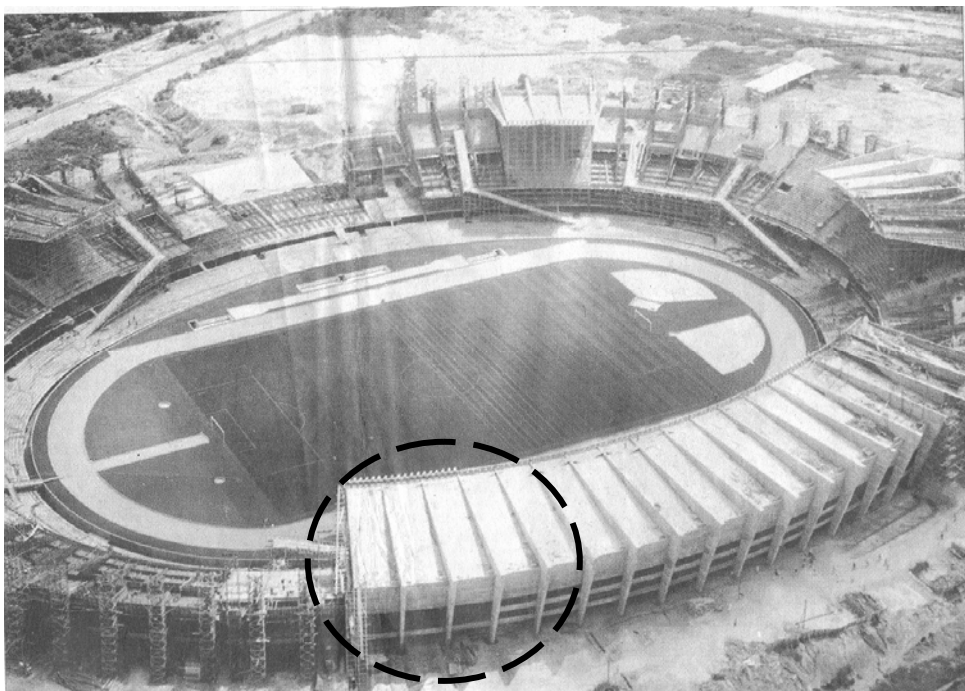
Foto tirada durante a construção, na qual pode-se observar, em destaque, a seqüência executiva da viga de fachada
